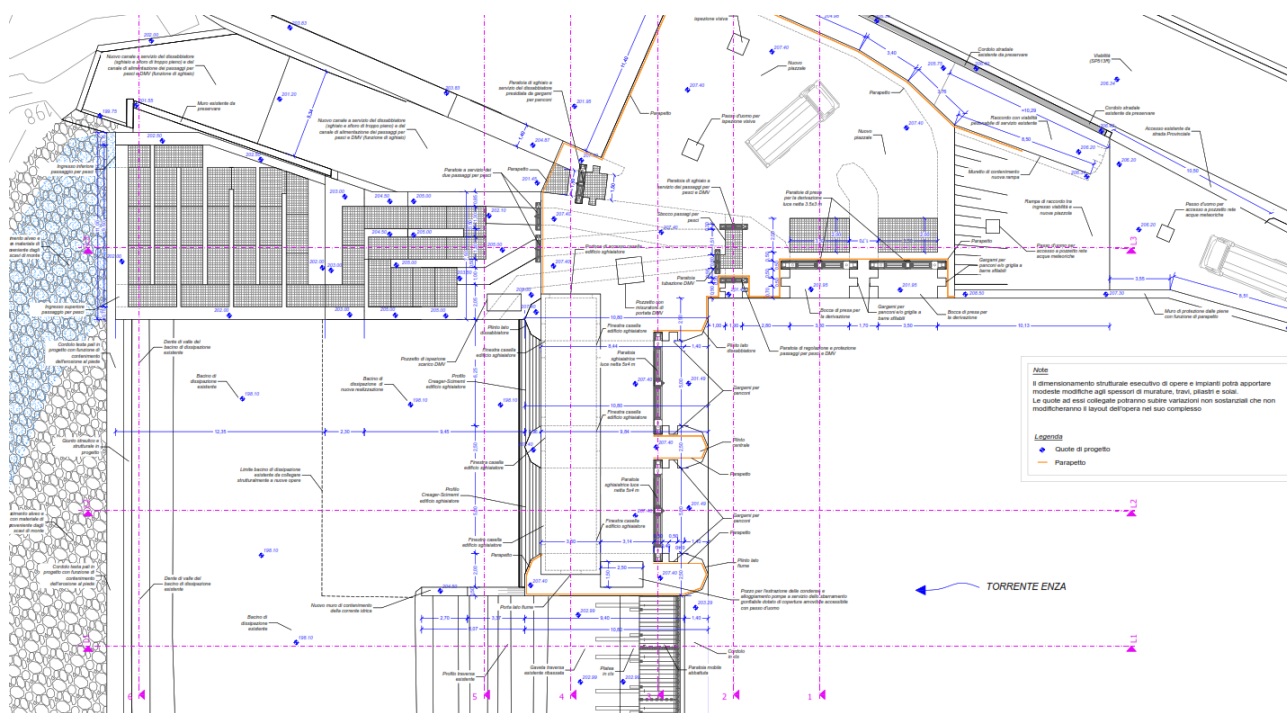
estratto planimetrico dell'area di intervento (tavola 3.1.3)
